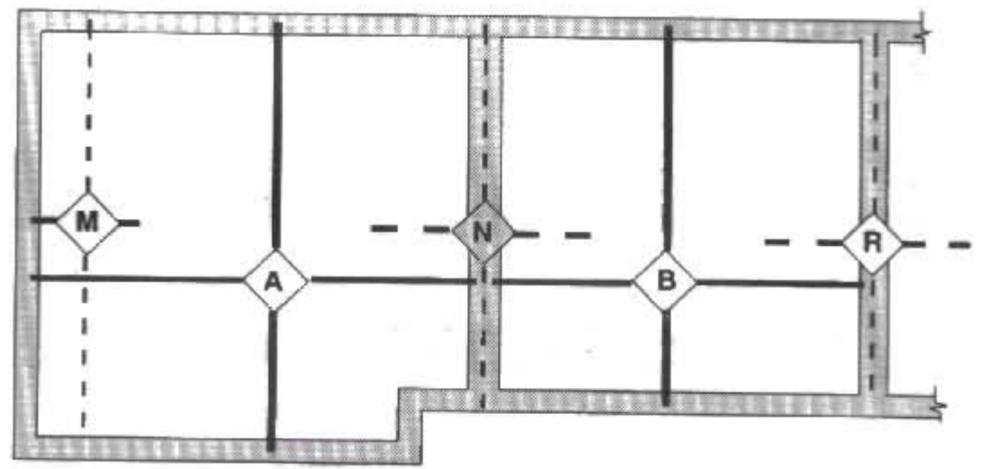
Représentation: dalles armées de panneaux treillis soudés 2^{ème} moyen
